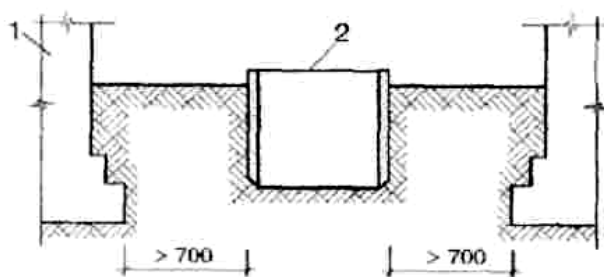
Схема кріплення стінок виїмки опускним колодезем: 1 – існуючі конструкції; 2 – опускний колодезь
